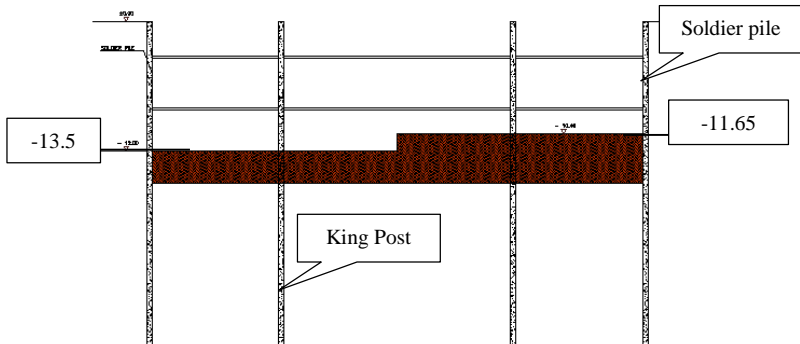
Pemasangan Strutting Baja Layer 2
